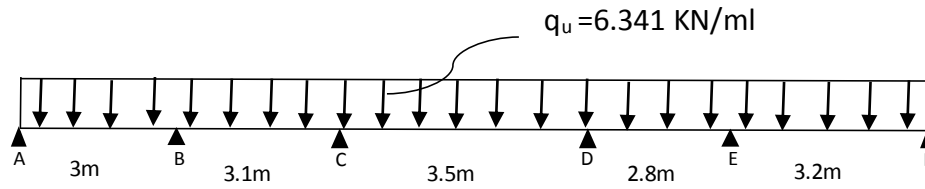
schéma de chargement de la poutrelle cinq travées à l'ELU
